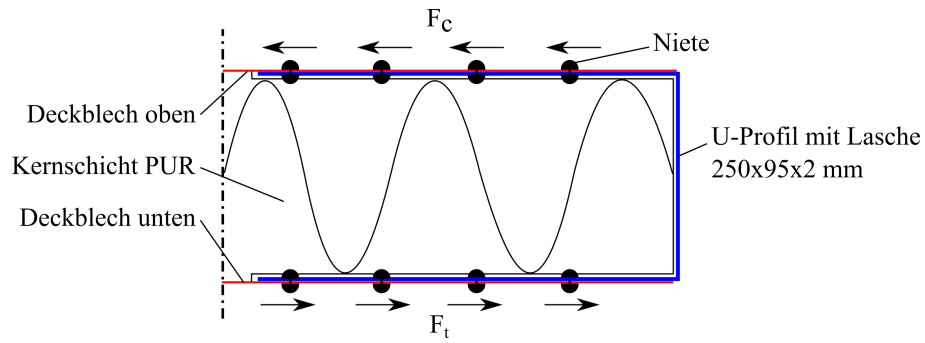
Anschluss Einschubling - Deckblech beim Typ 1 (Schnitt im Bereich der Laschen - schematisch)
